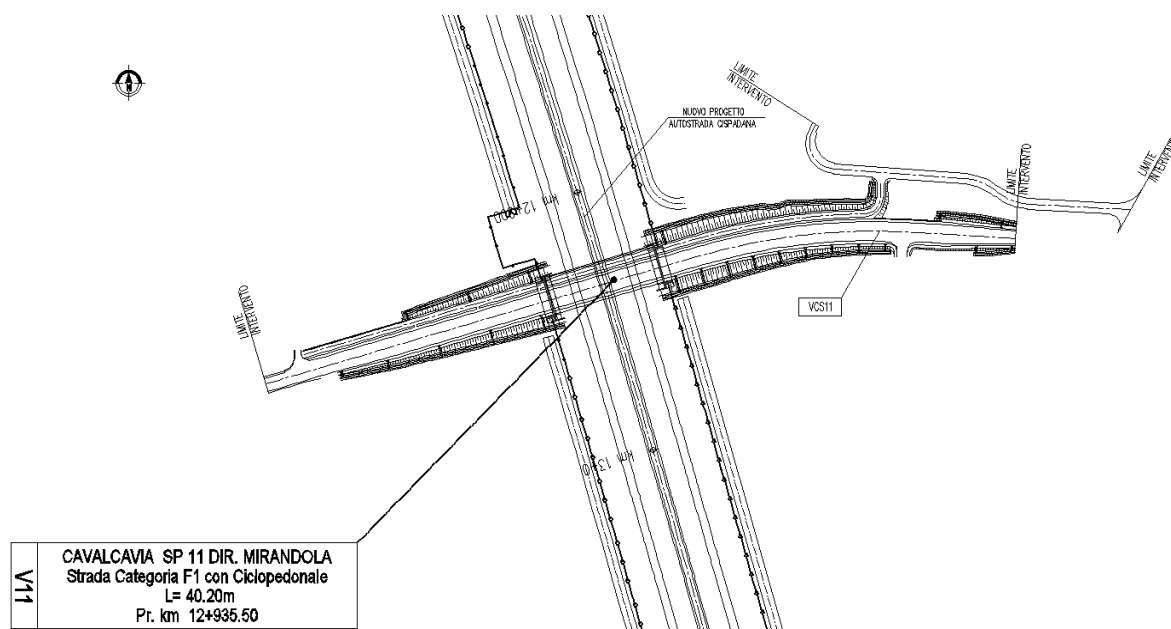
SCHEMA PLANIMETRICO DELLA INTERFERENZA TRA AUTOSTRADA E CAVALCAVIA SP11 DIREZIONE MIRANDOLA
